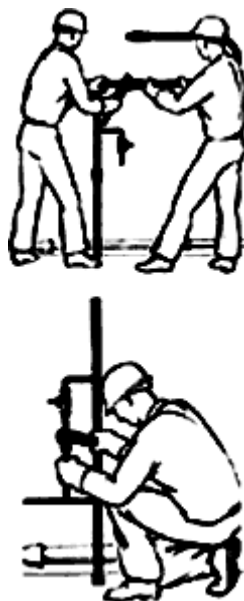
Прокладка трубопроводов внутреннего водопровода на резьбе
